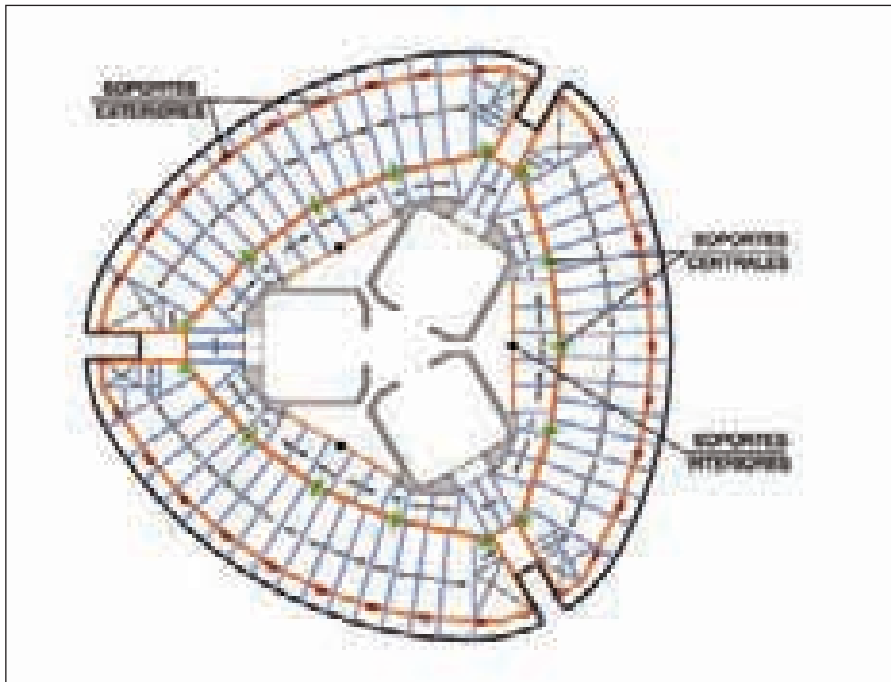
, Esquema general con disposición de soportes en las plantas tipo.
